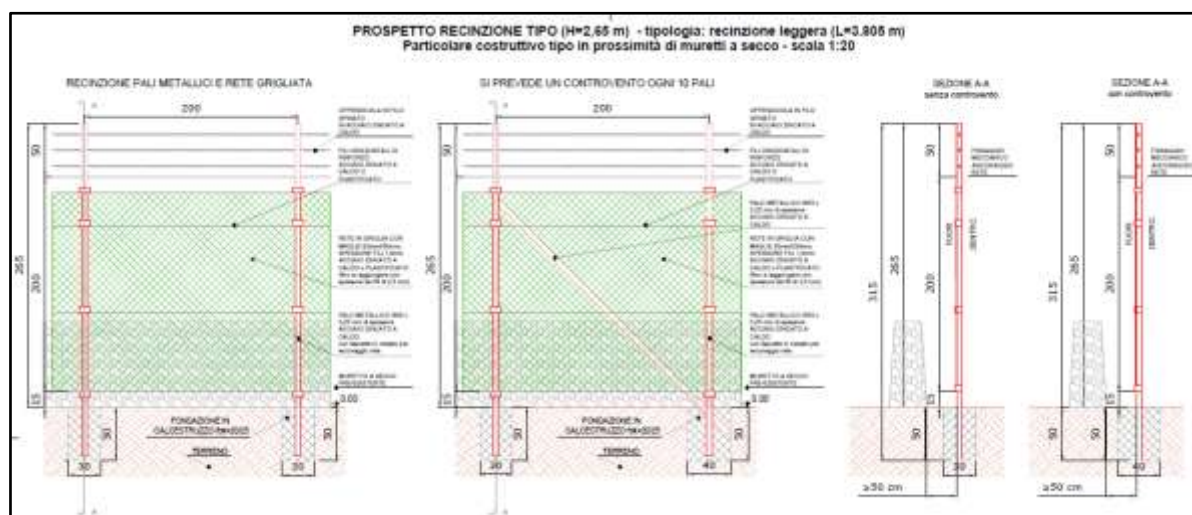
Rappresentazione della recinzione tipo in prossimità dei muretti a secco.
